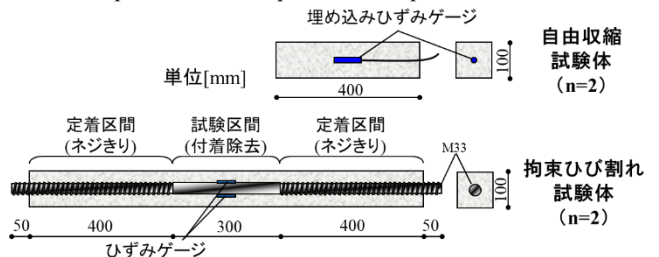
自由収縮試験体および拘束ひび割れ試験体の詳細 (Specimen of Autogenous Shrinkage and Specimen of Restrained Shrinkage Cracks)
